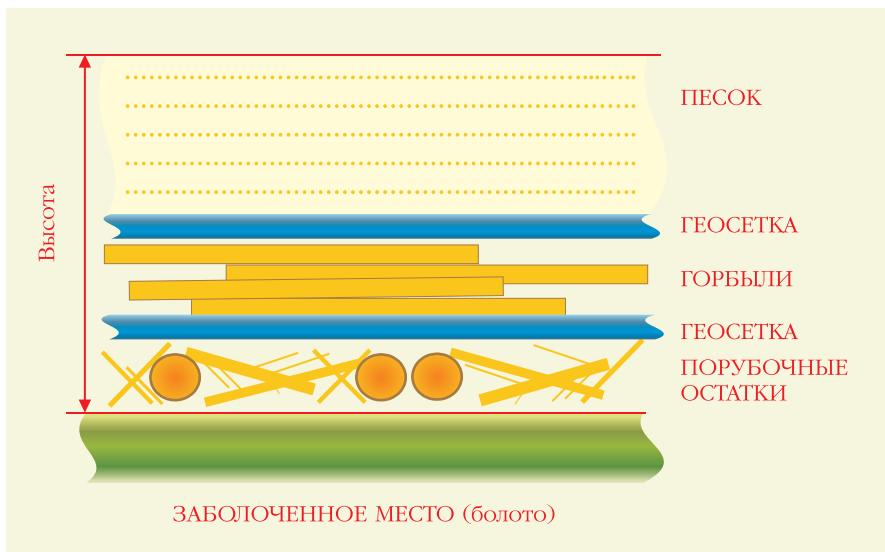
Схема лесовозной дороги для переувлажненных грунтов
